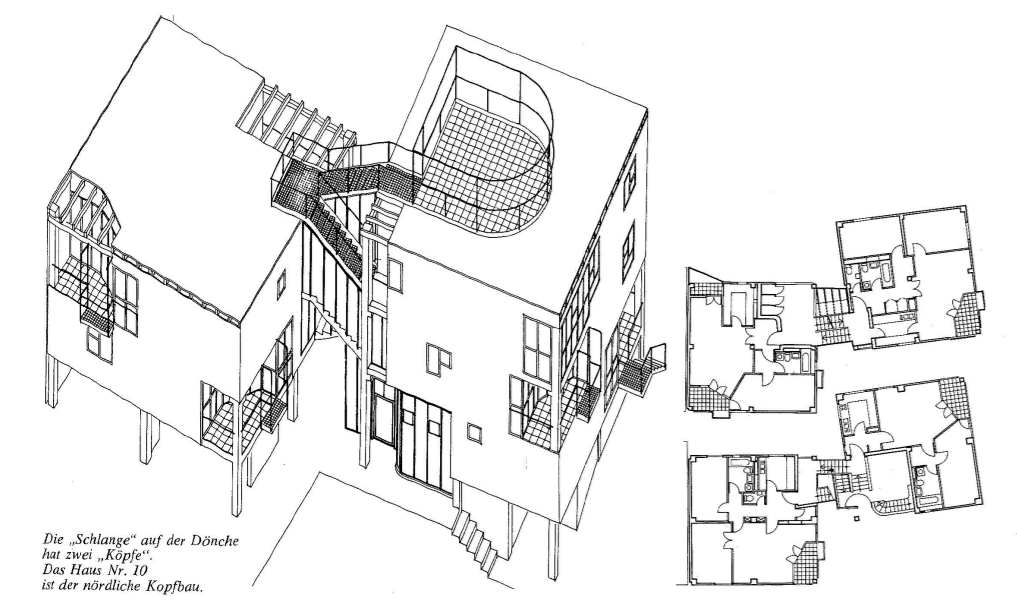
axonometrische Darstellung und Grundrisse des Hauses Nr. 10 von Steidl, 1982
